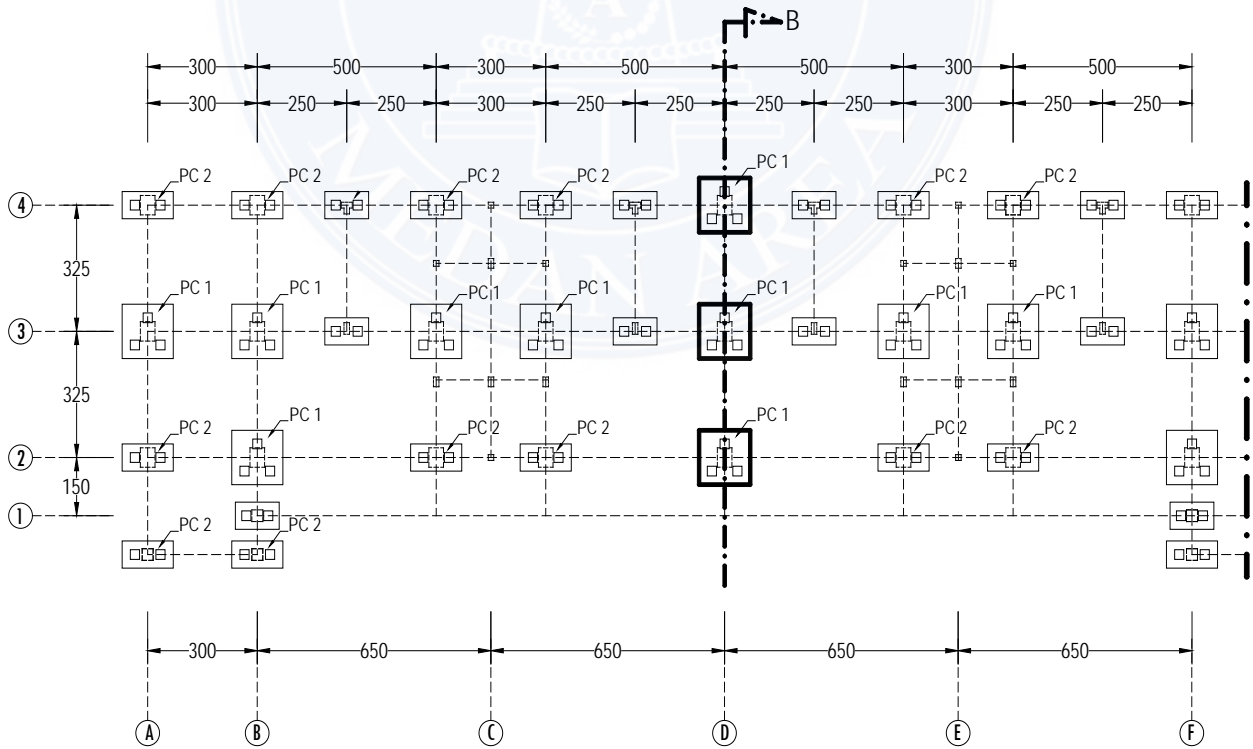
Section PC1 Pondasi Tiang Pancang
